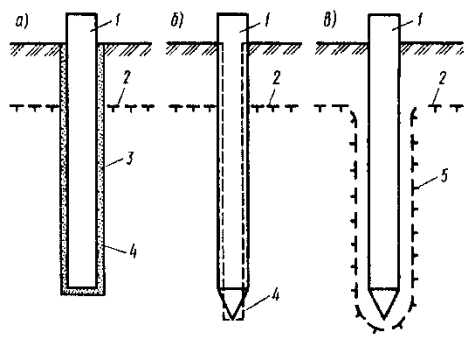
Способы погружения свай в вечномёрзлый грунт:
